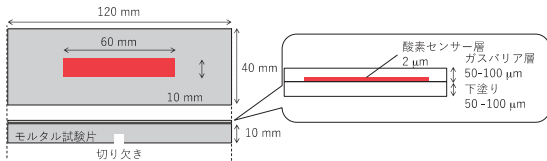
モルタル試験片へのひび割れ検出塗料施工例
